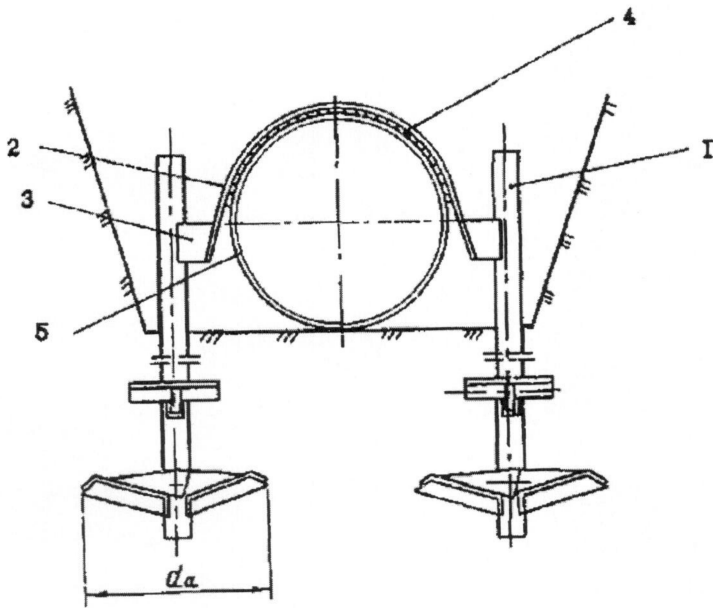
Схема конструкции раскрывающегося анкерного устройства типа AP-401:
